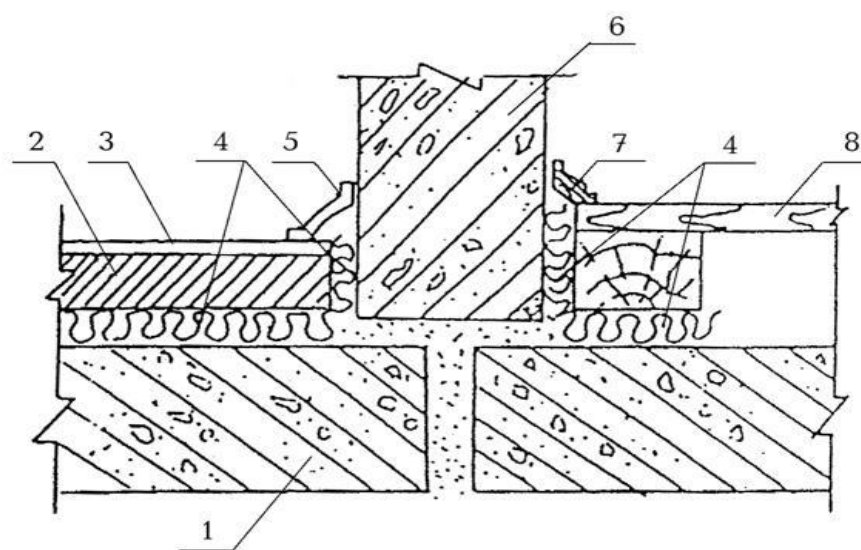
Схема конструктивного решения узла примыкания пола на звукоизоляционном слое к стене (перегородке): 1 – несущая часть междуэтажного перекрытия; 2 – бетонное основание пола; 5 – гибкий пластмассовый плинтус; 6 – стена; 7 – деревянная галтель; 8 – дощатый пол на лагах.
